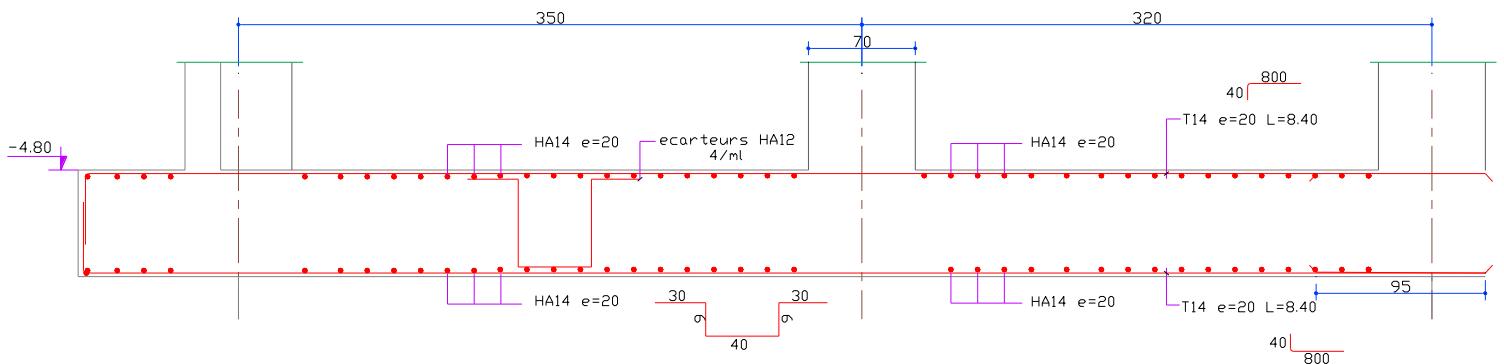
Exemple de coupe de ferrailage de la dalle de radier général sens x-x.
